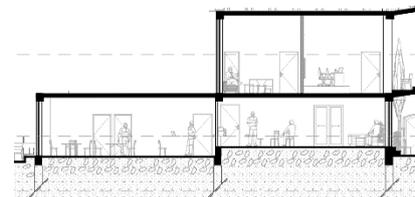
Coupe schématique du système poteaux-poutres, source: google image
